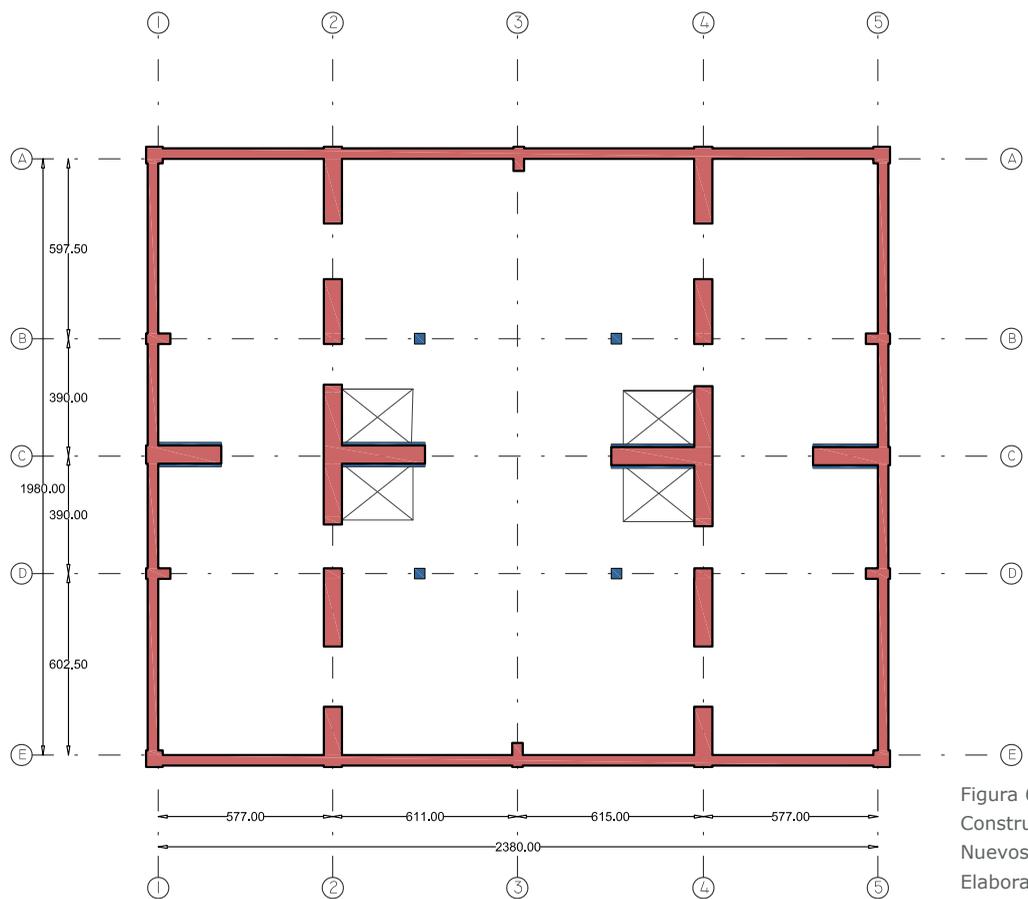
Construcción Muros Nuevos Piso -2 y -1. Elaboración Propia
